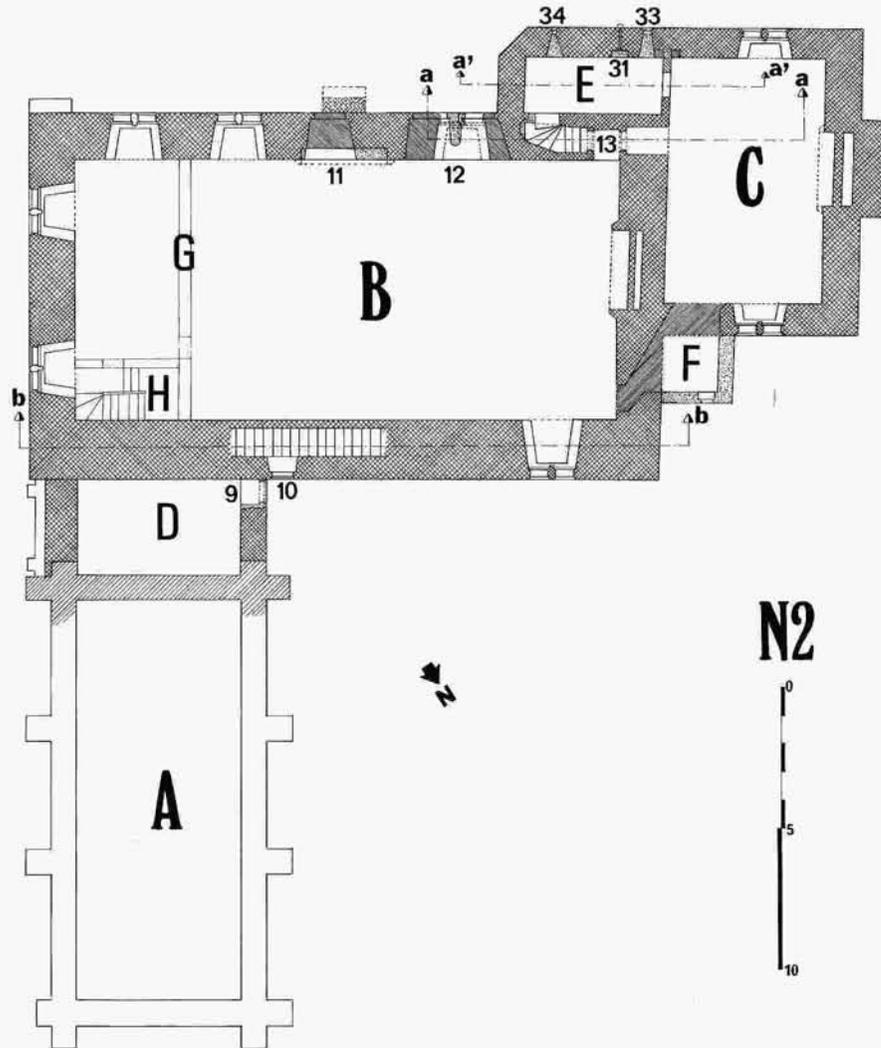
PLAN DES BÂTIMENTS DU « DONJON » AU NIVEAU 2, SECOND NIVEAU DU BÂTIMENT PRINCIPAL B
